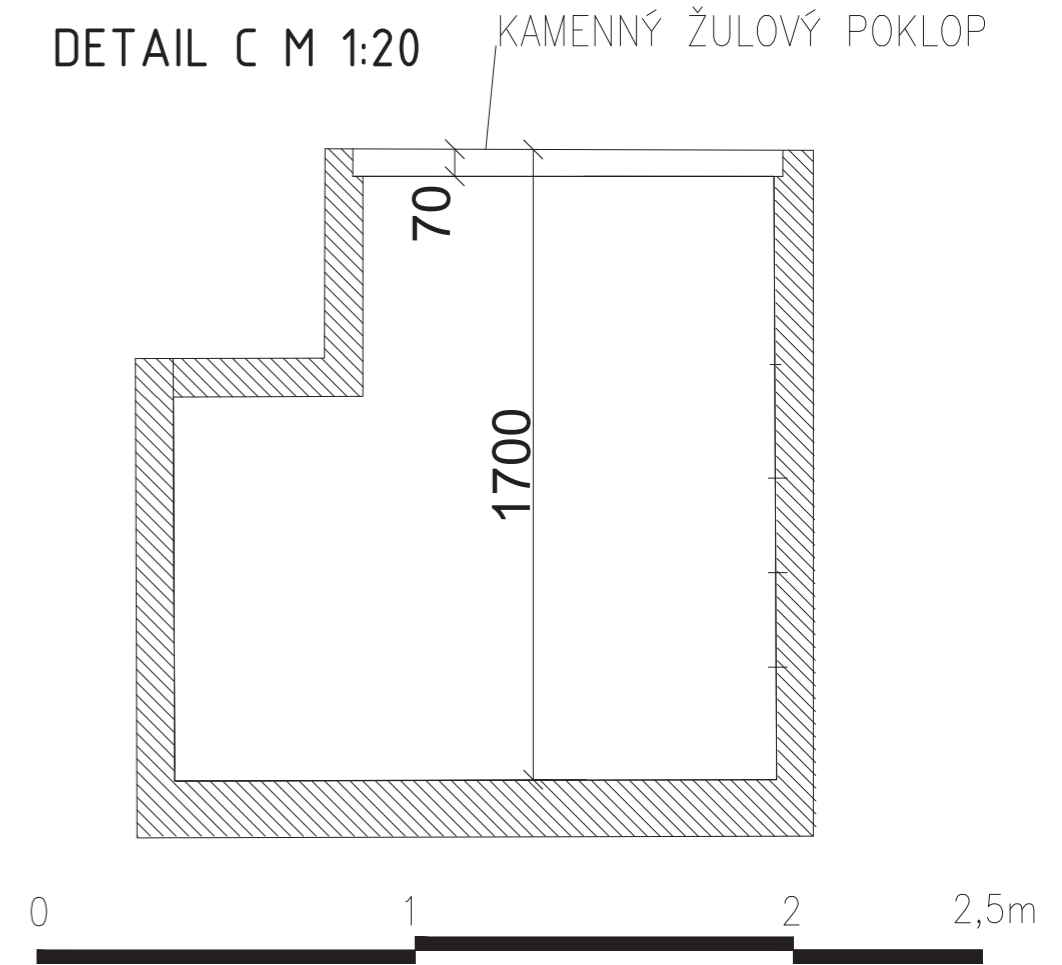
DETAIL C, TECHNOLOGICKÁ ŠACHTA M 1:50
